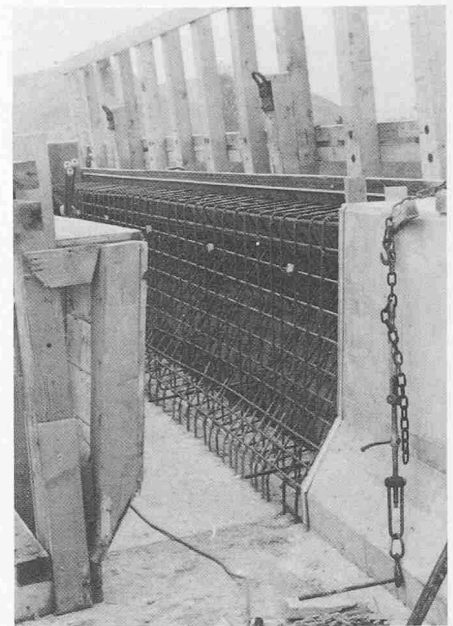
Stark bewehrte Brüstung mit teilweise geneigter Schalung wird nachträglich betoniert
